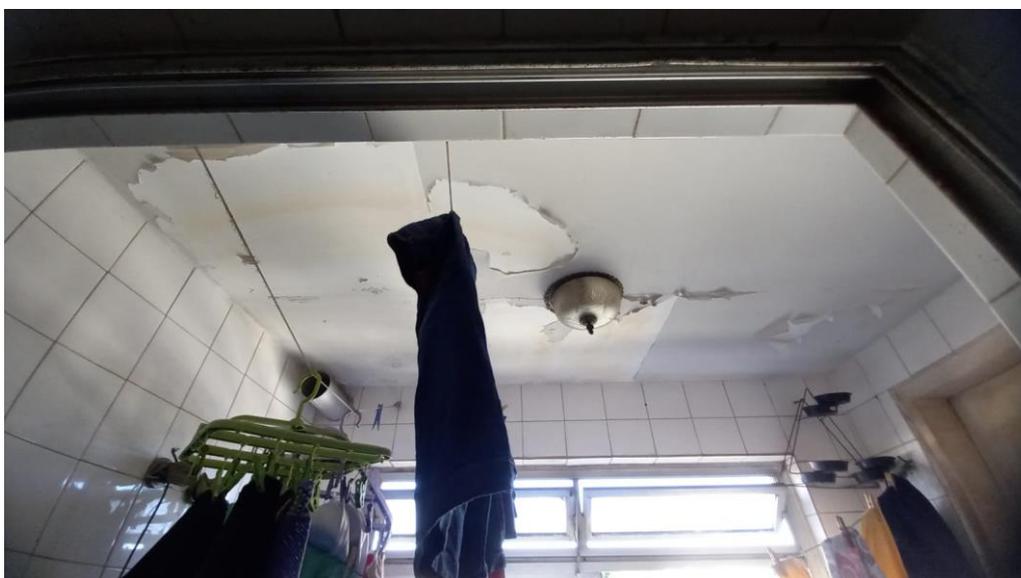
Área de Serviço, o banheiro não foi possível fotografar, está desativado, é usado como depósito de caixas.
